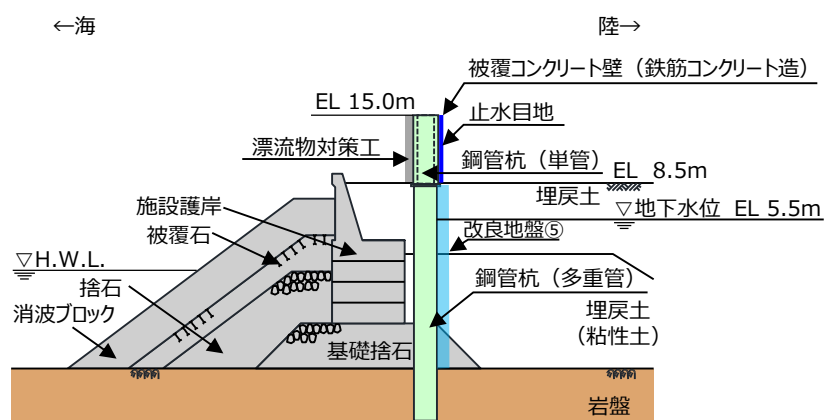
防波壁（多重鋼管杭式擁壁）の構造概要図（断面図）
